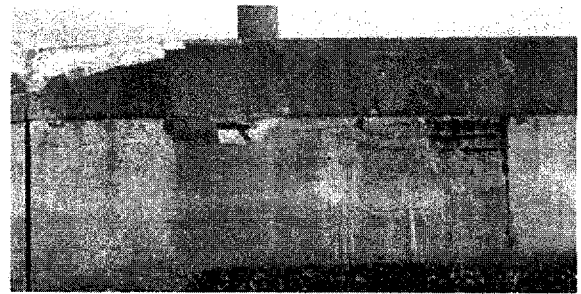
本体工鉄筋の広範囲露出状況（気中部）
